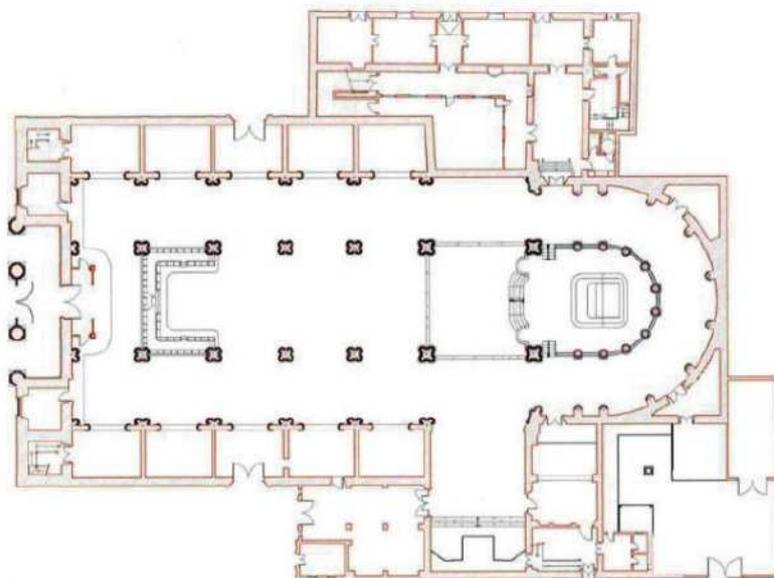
Planta del Templo según plano del arquitecto José Miguel Márquez Zarate, autor del proyecto de reconstrucción de la catedral¹⁸
